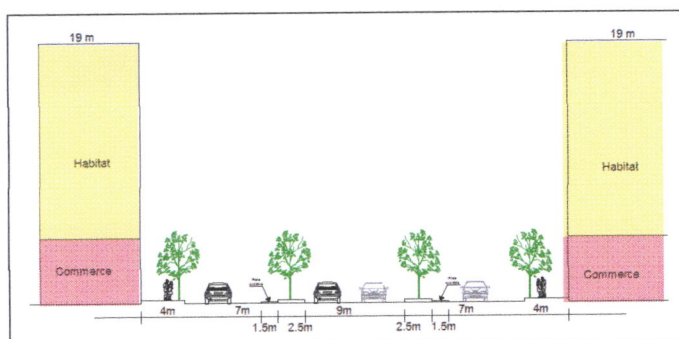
Coupe sur voie principale.(est-ouest)
